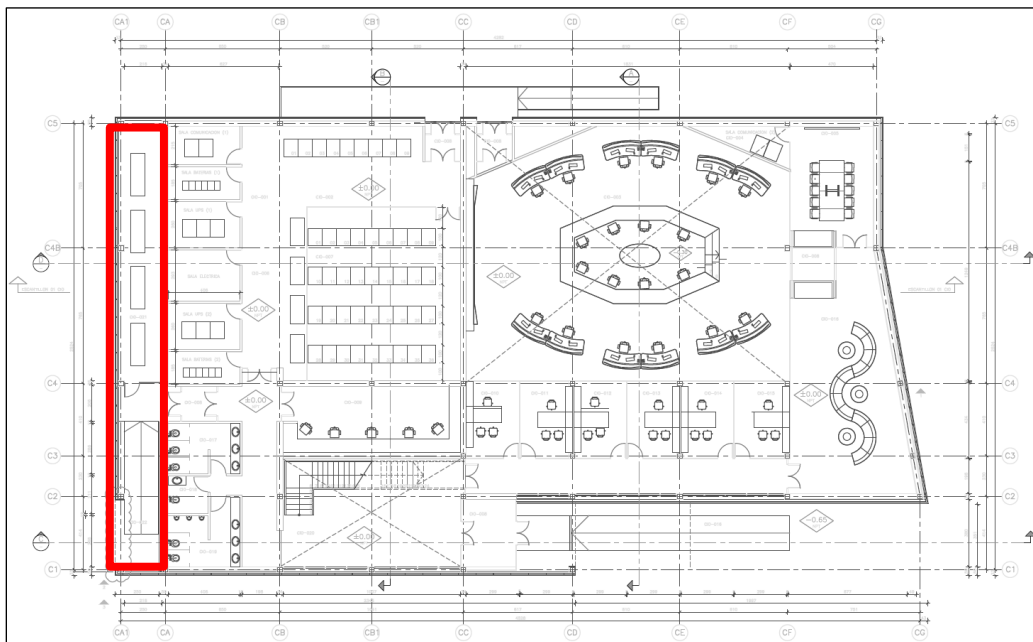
Layout Primer Nivel Existente - CIO&G División Mina Ministro Hales
